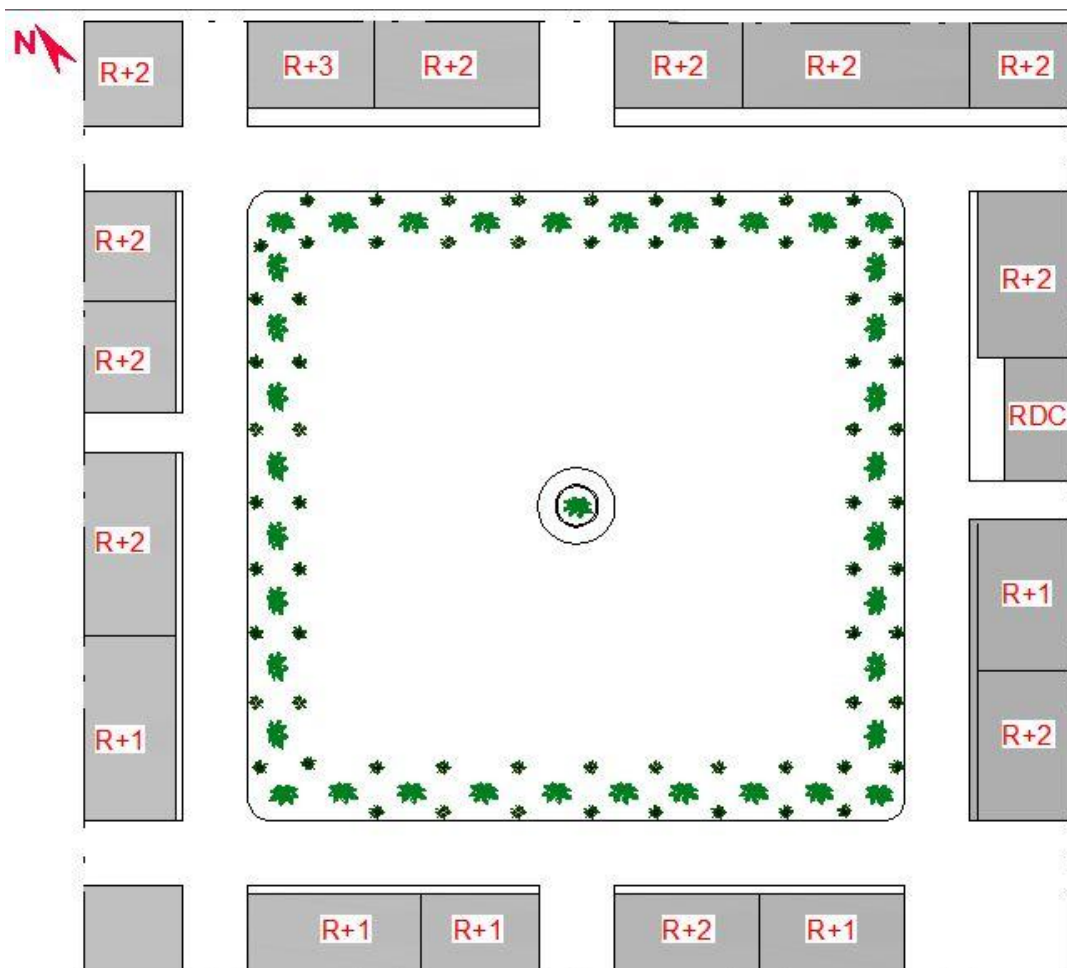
Plan d'aménagement de la place du 1er Novembre dessiné sur Autodesk-Autocad.
